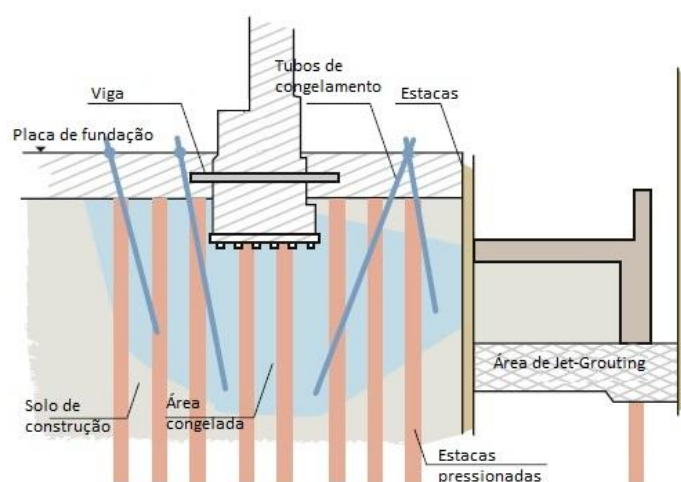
Esquema das fundações do Museu da ilha, Berlim (Fonte: adaptado de BAYER et al., 2010)
